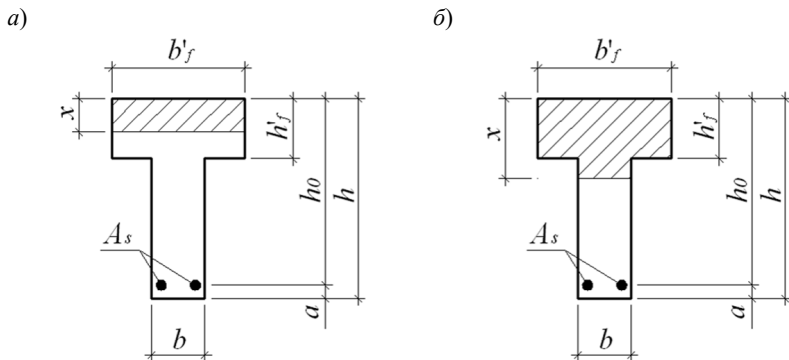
Положение границы сжатой зоны в тавровом сечении изгибаемого железобетонного элемента: a – в полке; b – в ребре
